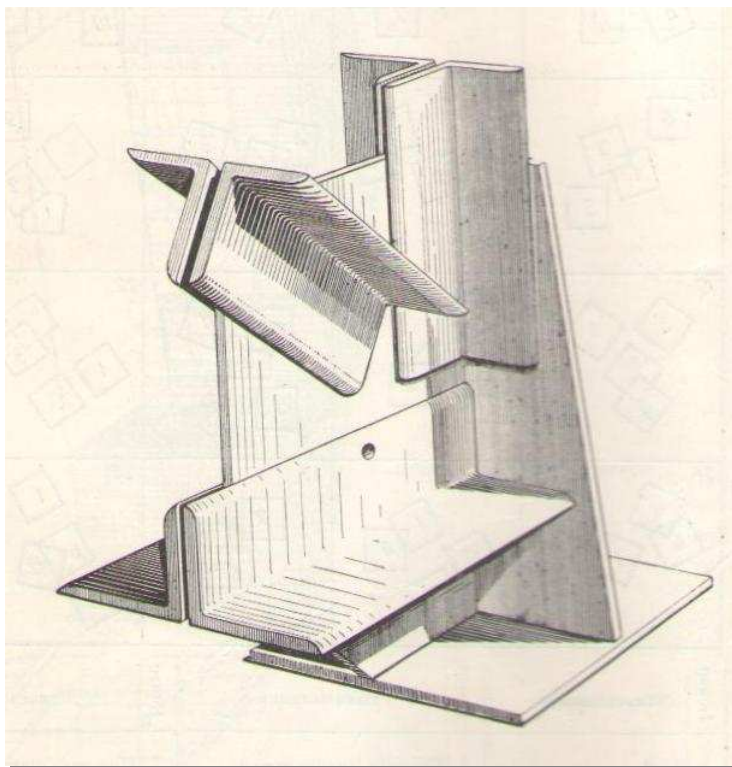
Наглядное изображение опорного узла металлической фермы
